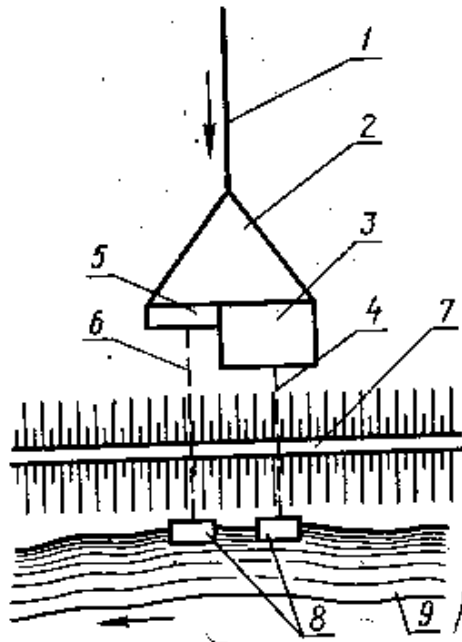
Загальна схема гідровузла з осушувальною насосною станцією:
